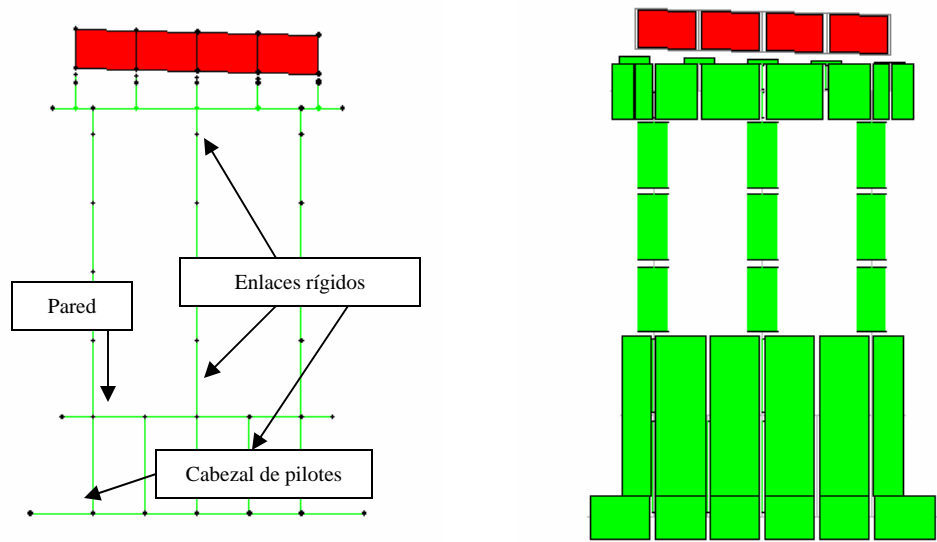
Elementos de pórtico en la pilastra 9 del modelo 3D
